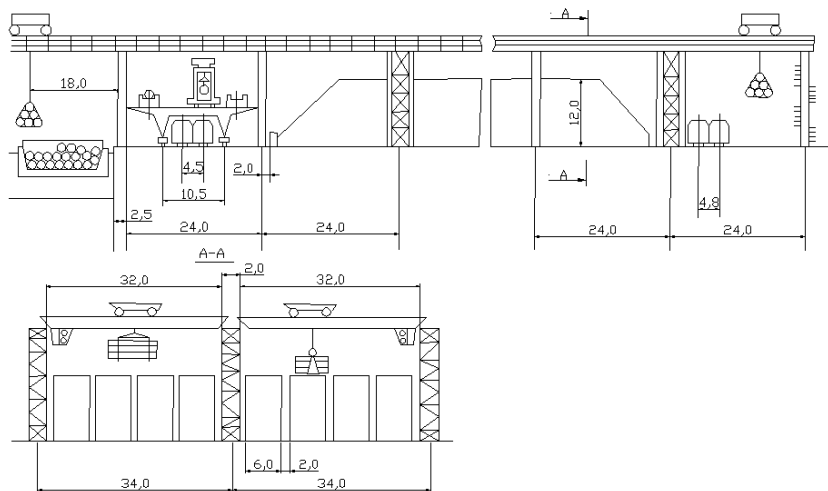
Схема механизации перегрузки леса с мостовыми кранами на эстакадах
